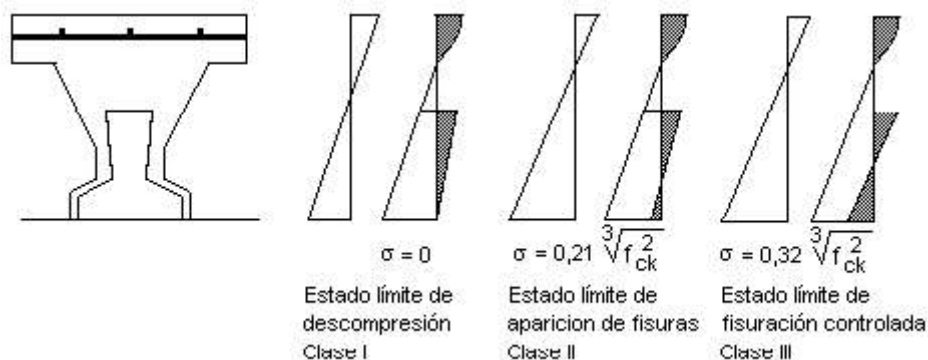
Estados límites de fisuración en forjados con viguetas o losas pretensadas
